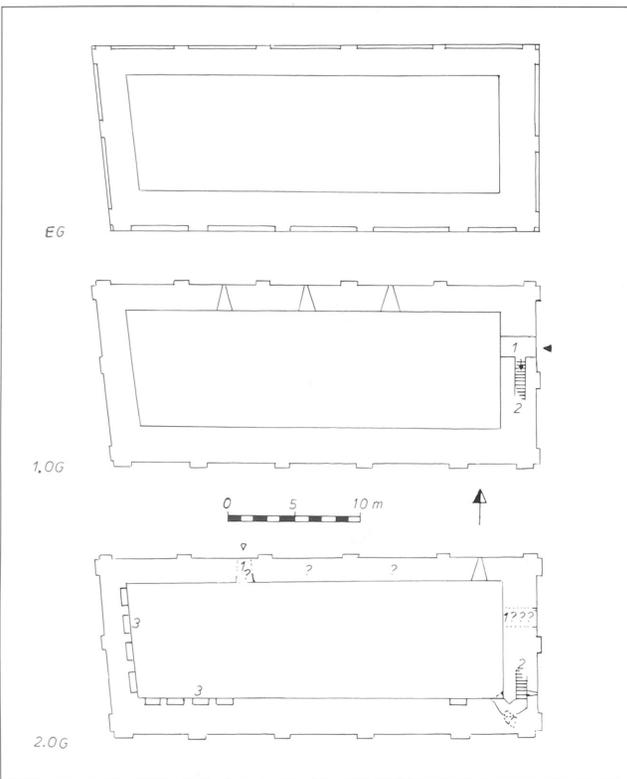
Chepstow, Grundrisse (Umzeichnung nach Renn).
